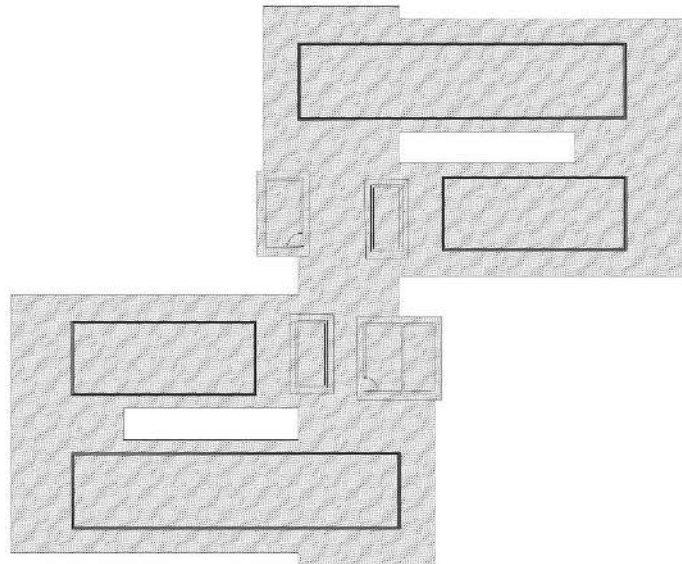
Skematik Bangunan – Lantai 3-11
